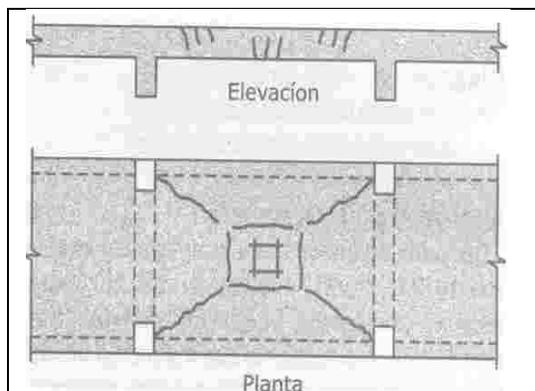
Fisuras de flexión en losas²⁰
